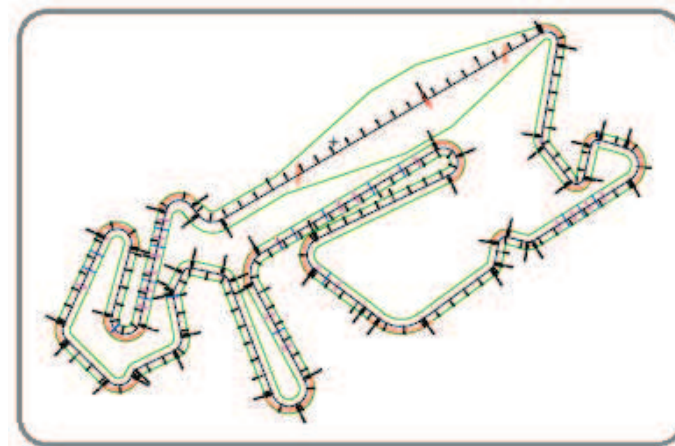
Planta del nou traçat del circuit.
